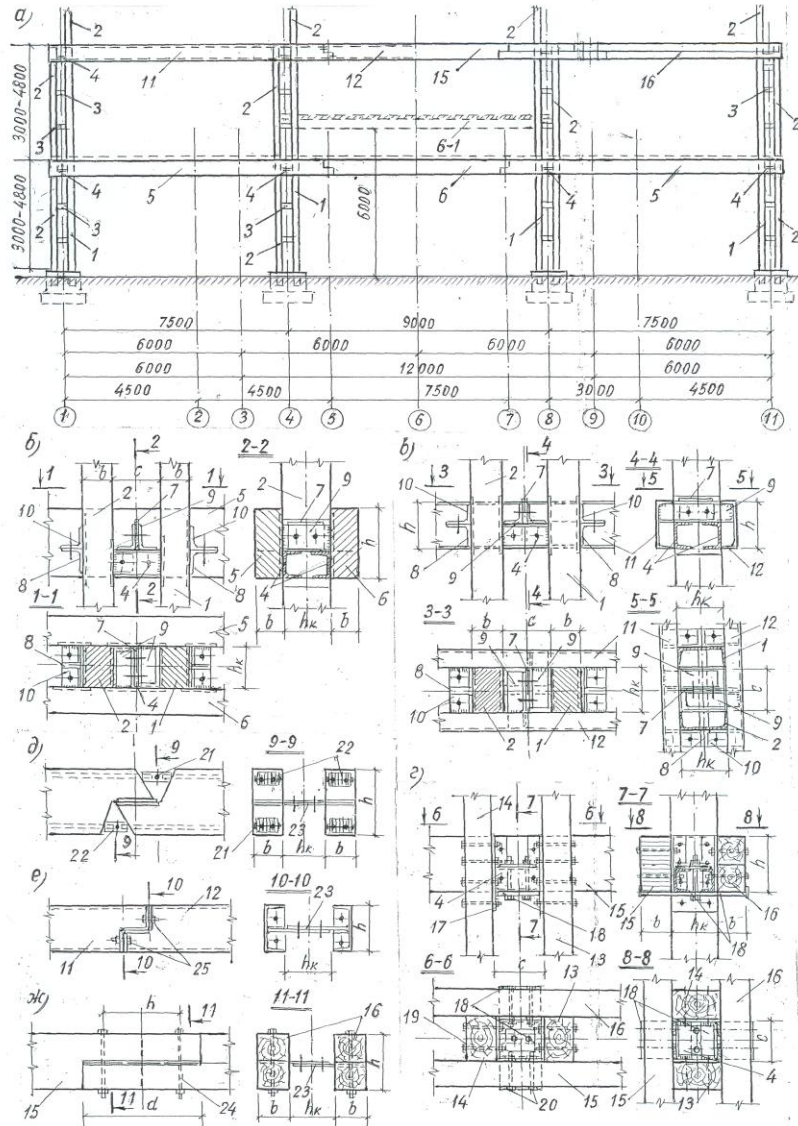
Збірний каркас багатопверхових будинків із нерегулярною сіткою, колон: а – поперечний розріз; б, в, г, д, е, ж – вузли і стики; 1 і 2 – збірні елементи двовіткових колон; 5 і 6 – збірні елементи ригелів каркаса; б) для залізобетонного каркаса, виконаного з однотипних великорозмірних збірних елементів прямокутного перерізу (1÷6); в) для металевго каркаса, виконаного з однотипних великорозмірних прокатних профілів (швелерів) 1, 2, 11, 12); г) для дерев'яних каркасів, виконаних з однотипних великорозмірних елементів колон 13 і 14 та ригелів, із клеєних елементів прямокутного перерізу 15 або складених із двох суцільних елементів прямокутного перерізу 16
